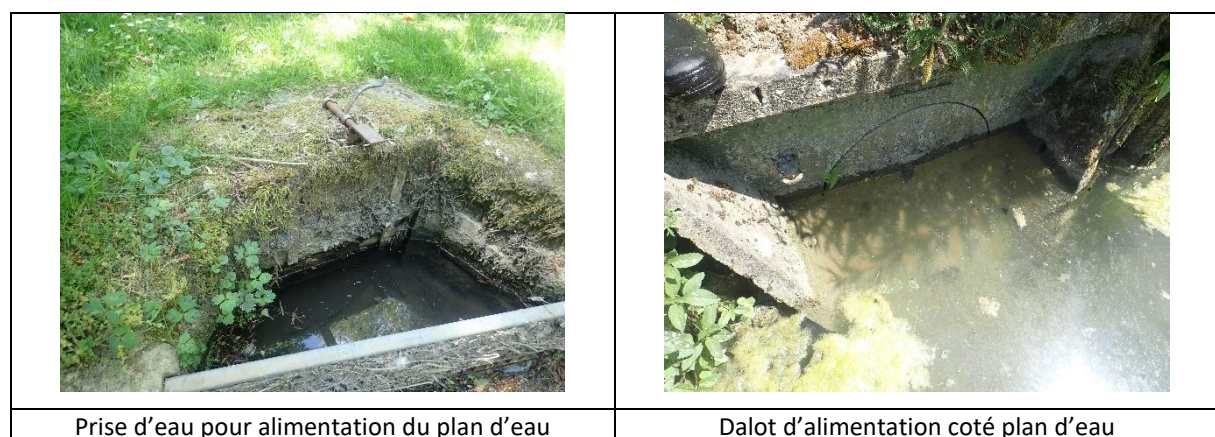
Alimentation du plan d'eau au Moulin Bondon
